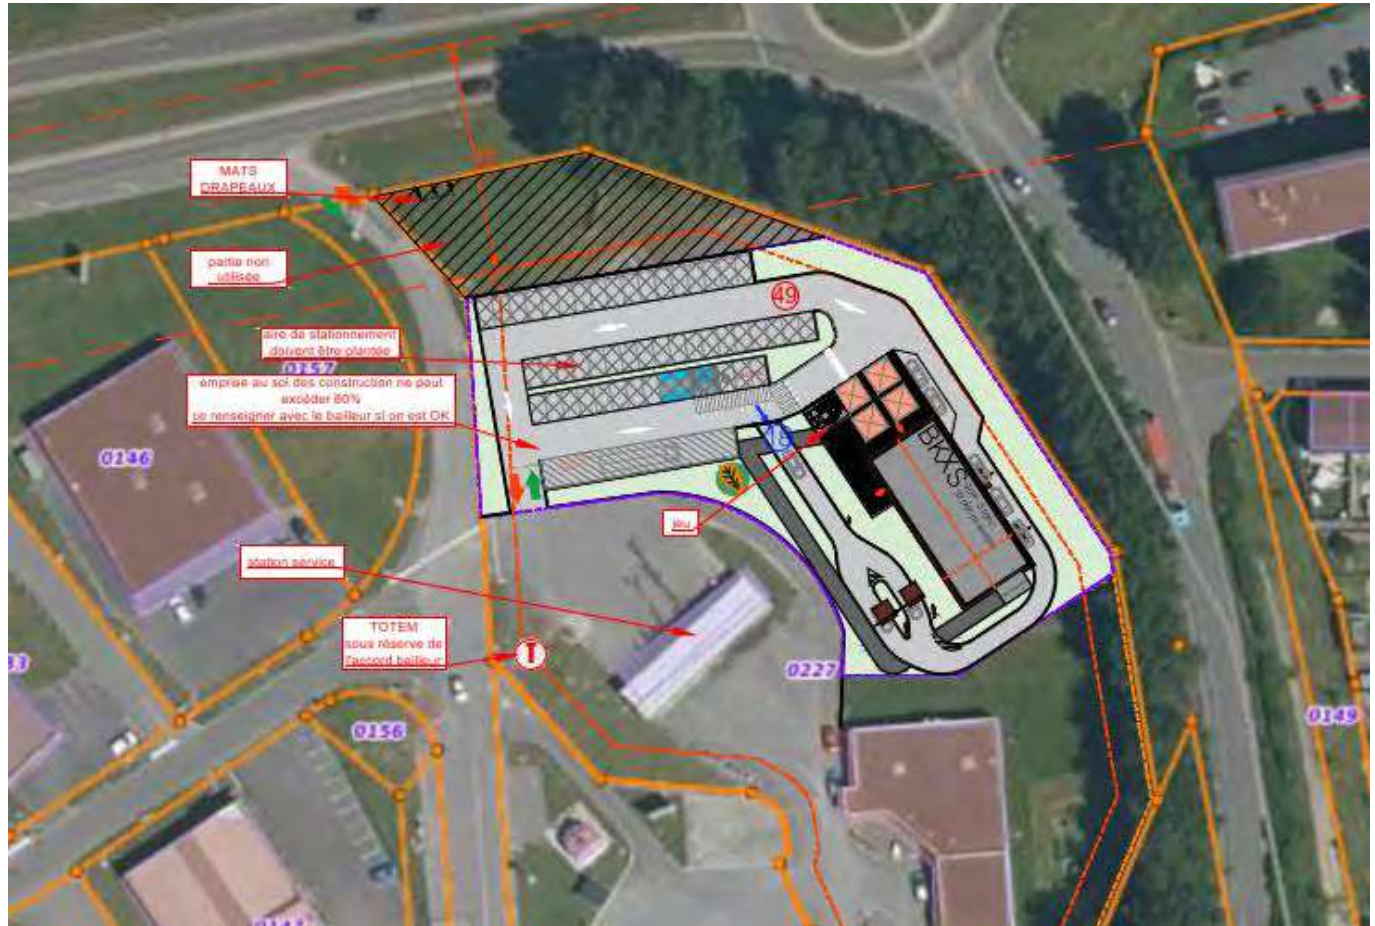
Extrait du plan de masse APS2C du 11/01/2023
